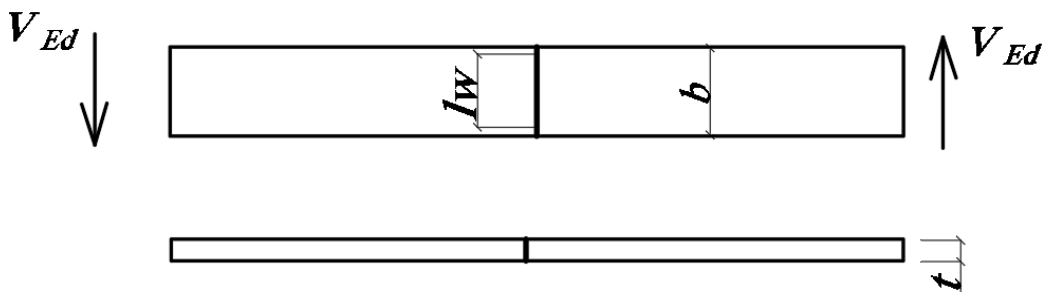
К расчету стыкового сварного шва на срез
